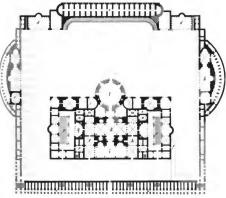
Grundriss der Thermen des Caracalla
